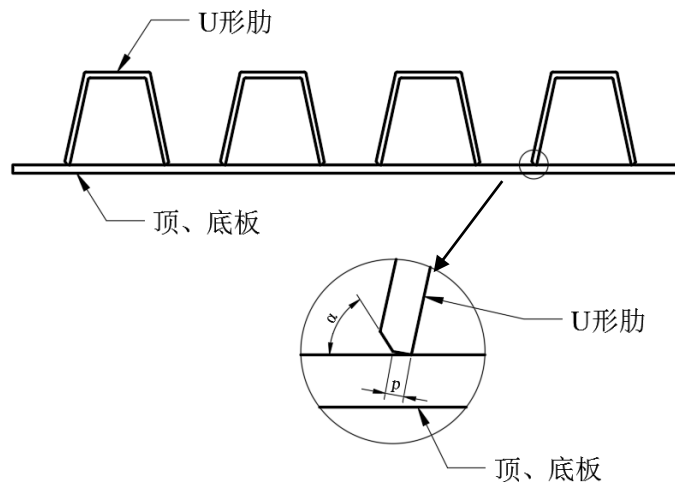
U 形肋角焊缝坡口类型示意图
